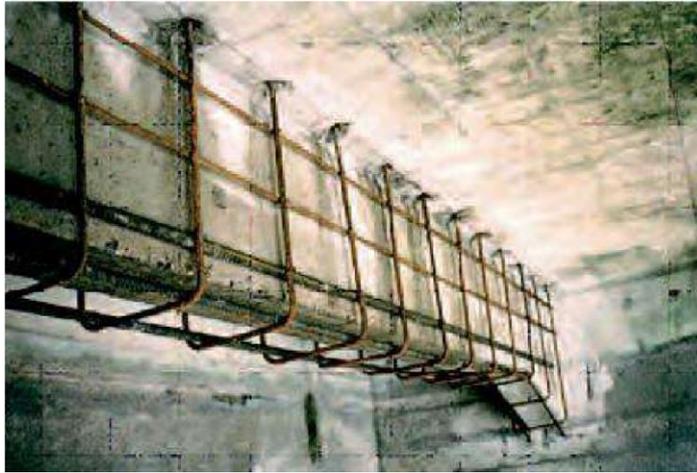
Renforcement avec ajout d'armatures de poutre
